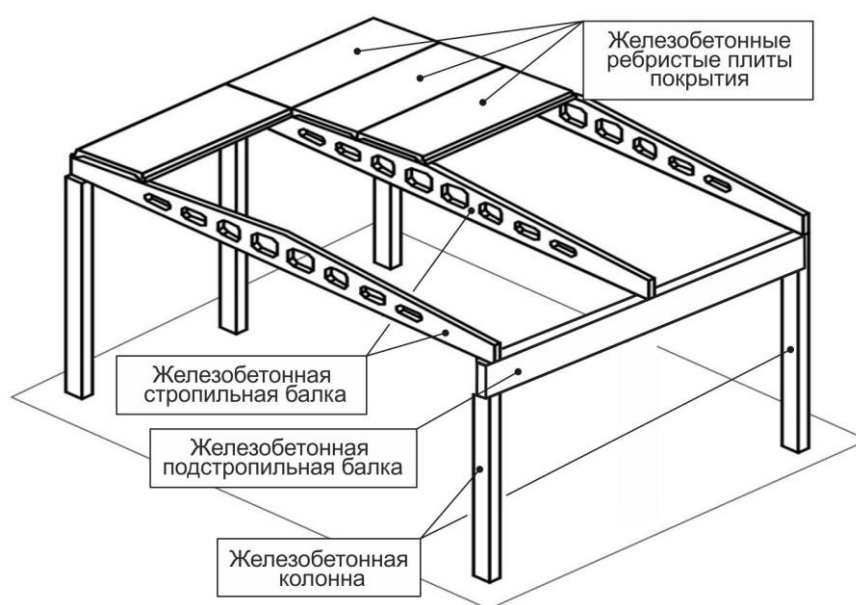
Железобетонное покрытие цеха пролетом 18 м из ребристых плит по стропильным балкам
